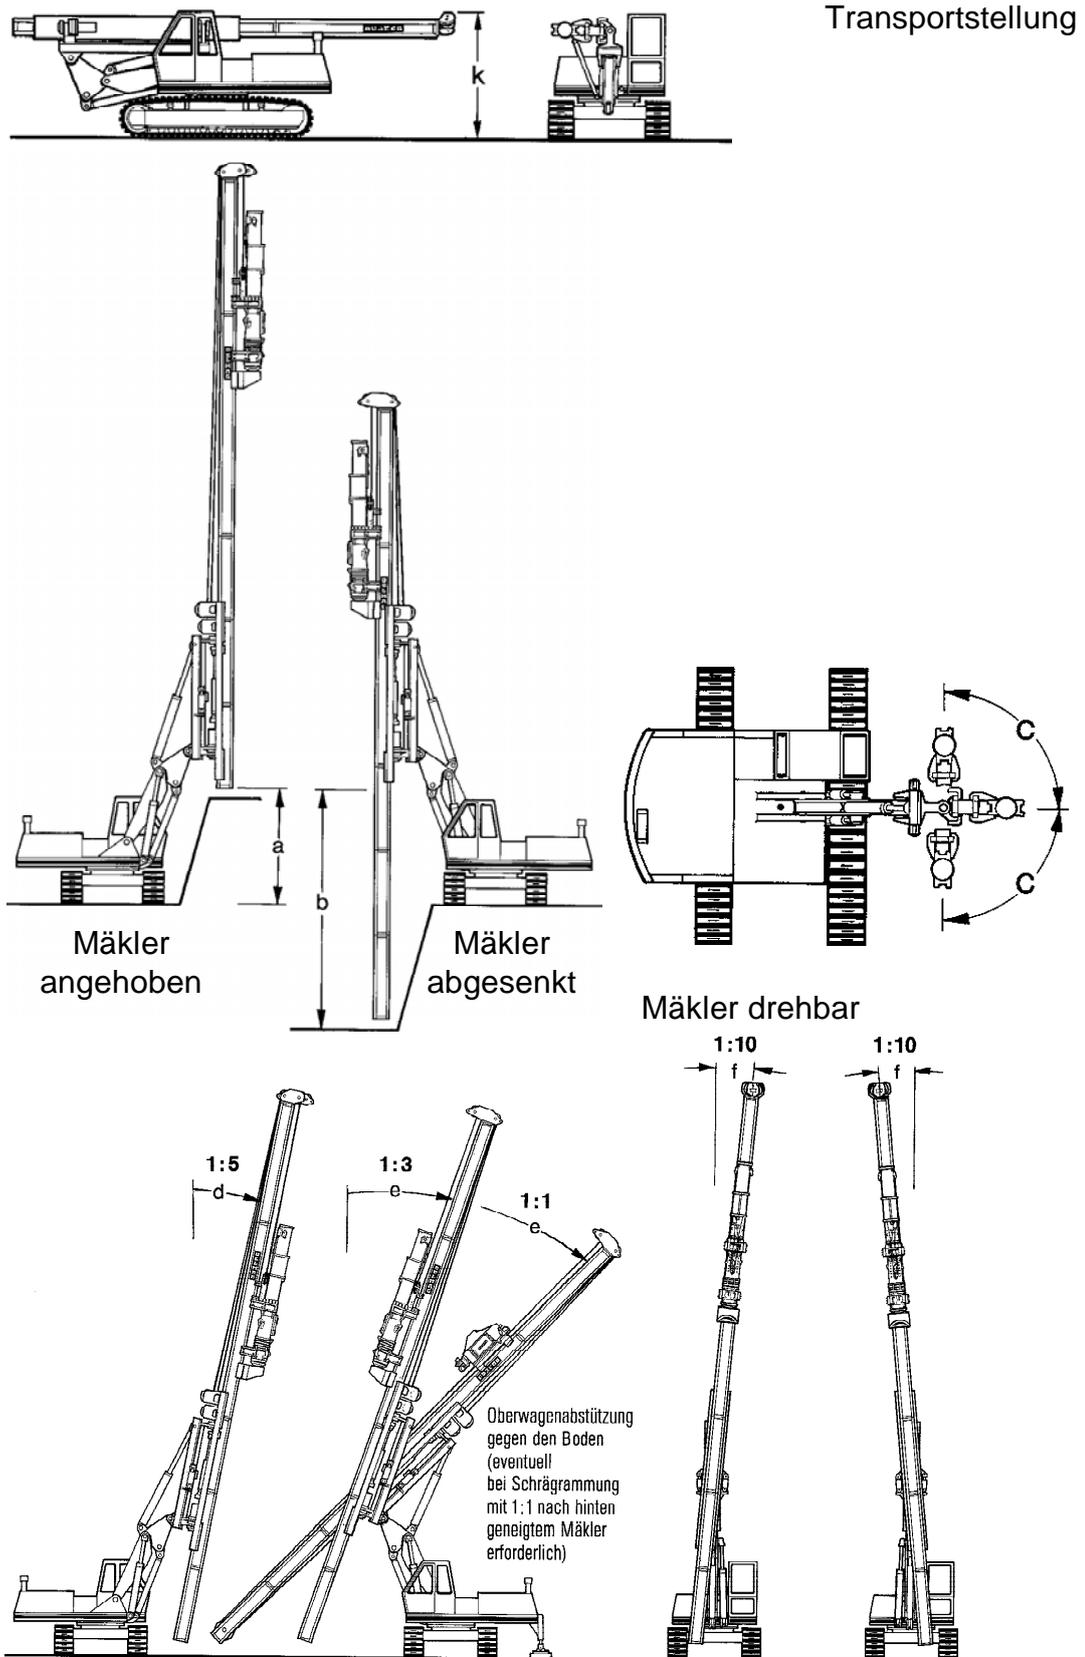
Hydraulikbagger mit Vibrohammer und teleskopierbarem Mäkler [3]
